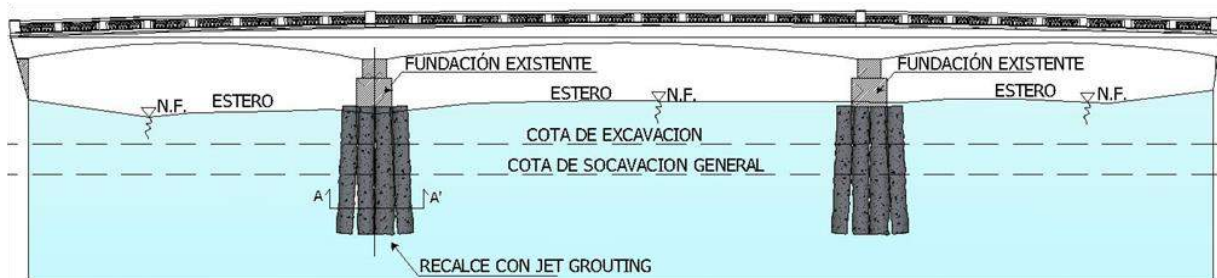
Ejemplo de propuesta de refuerzo de fundaciones de Puente
